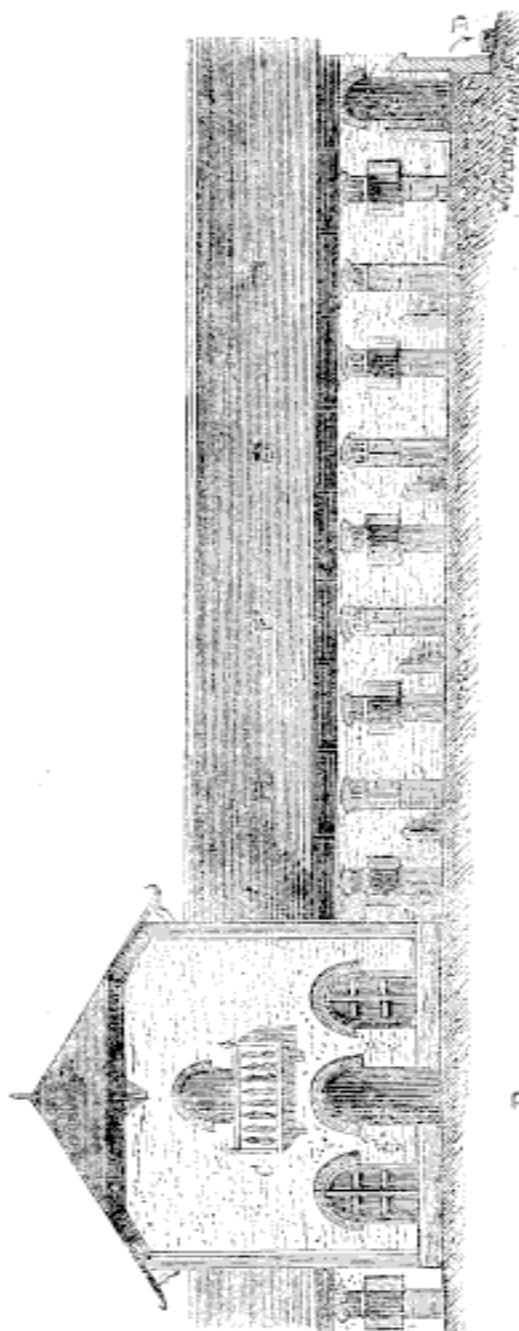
Élevation de la façade de la porcherie de Petit-Bourg.
